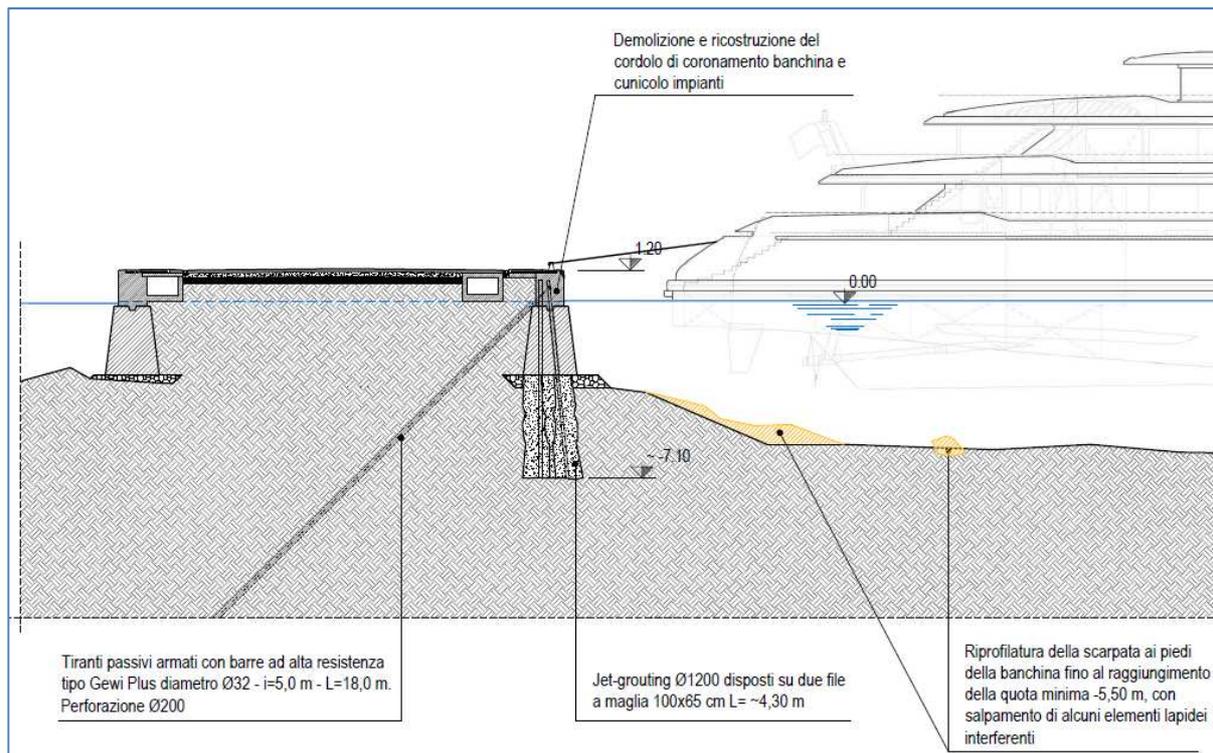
Sezione tipo rinforzo banchina Molo Langano
